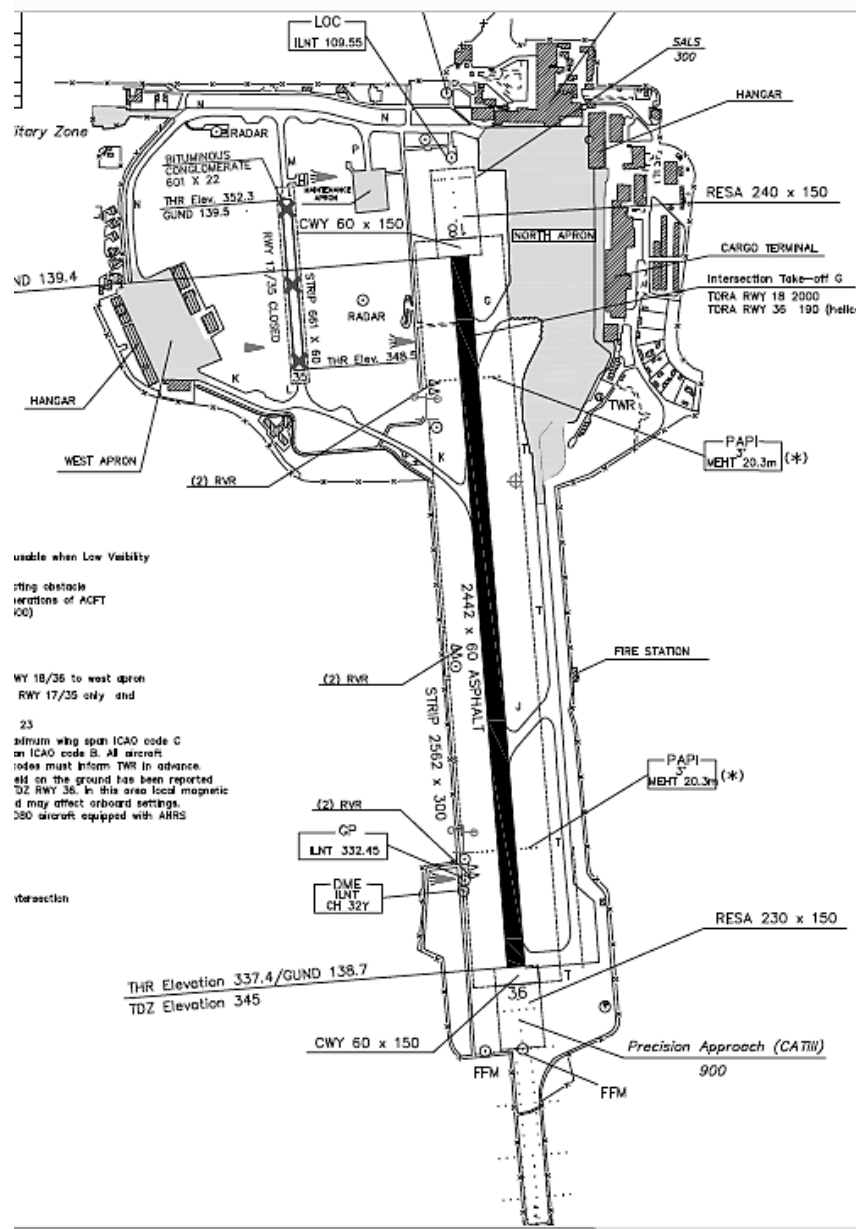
planimetria dell'aeroporto di Milano Linate (AIP ENAV).
